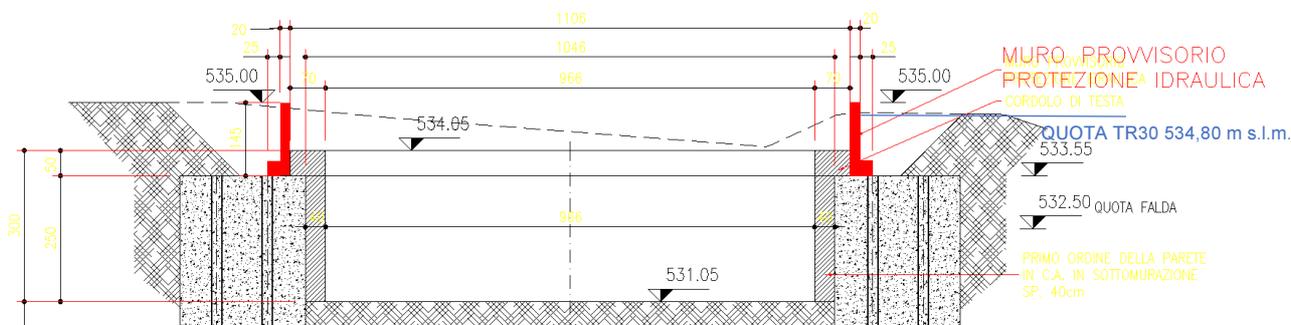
Dettaglio della sezione tipologica dello scavo per la realizzazione dei pozzi di fondazione dei plinti per la pila P3 BD. Il coronamento dei muri provvisori di protezione idraulica è posto ad una quota di 535 m s.l.m. con un franco minimo rispetto alla massaia quota della piena TR 30.
